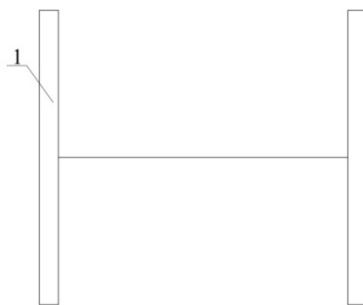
Крепление стен глубокого котлована по технологии «стена в грунте»: 1 – железобетонные подпорные стенки
